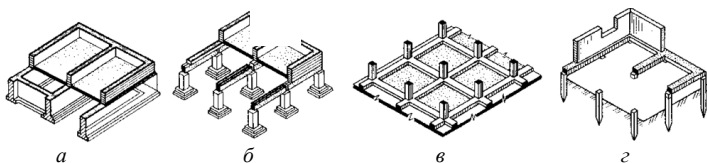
Виды фундаментов: а – ленточный; б – столбчатый; в – сплошной; г – свайный
